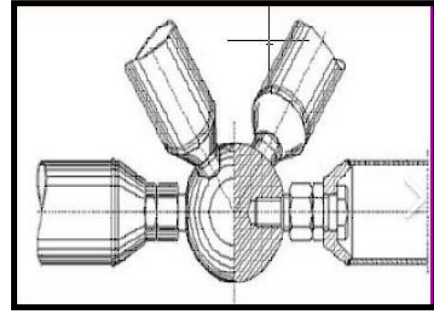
les nœuds dans la construction en acier.¹³⁰
